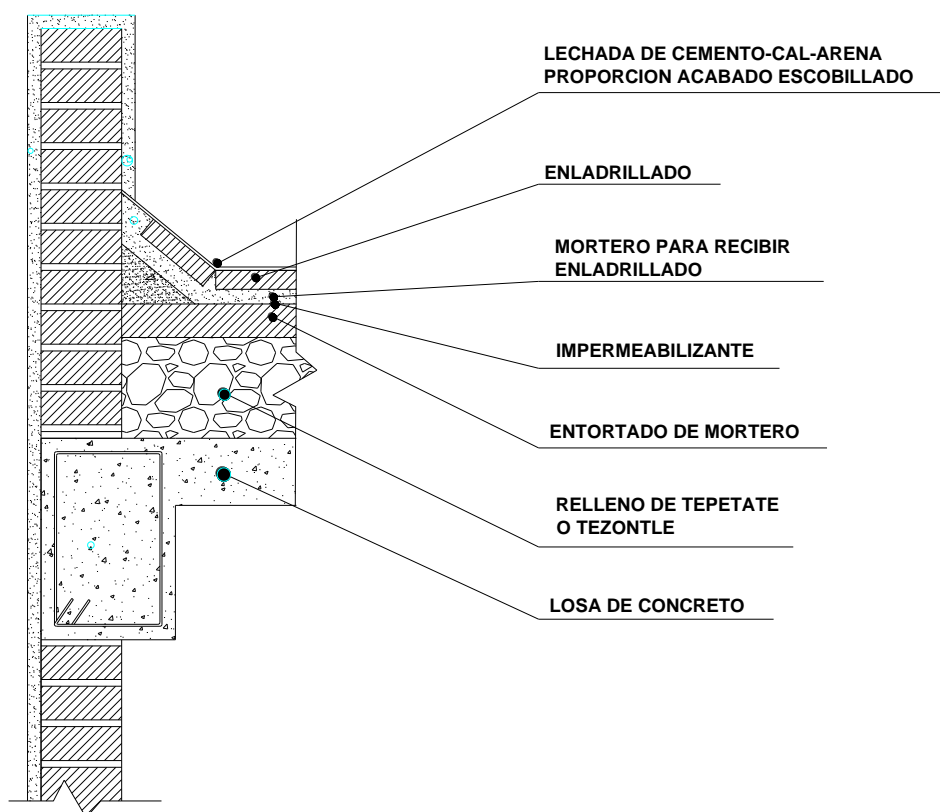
detalle constructivo estándar, terrado con enladrillado en azotea
